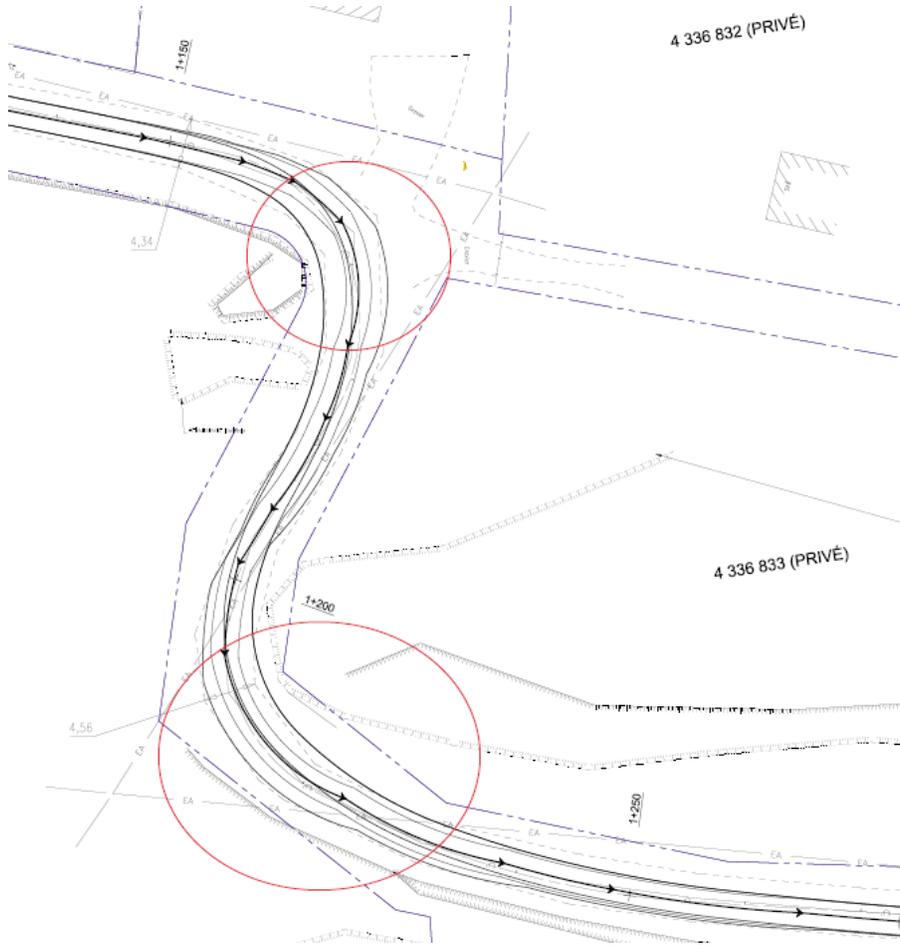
Dépassement plate-forme carrossable 1+165 à 1+225
